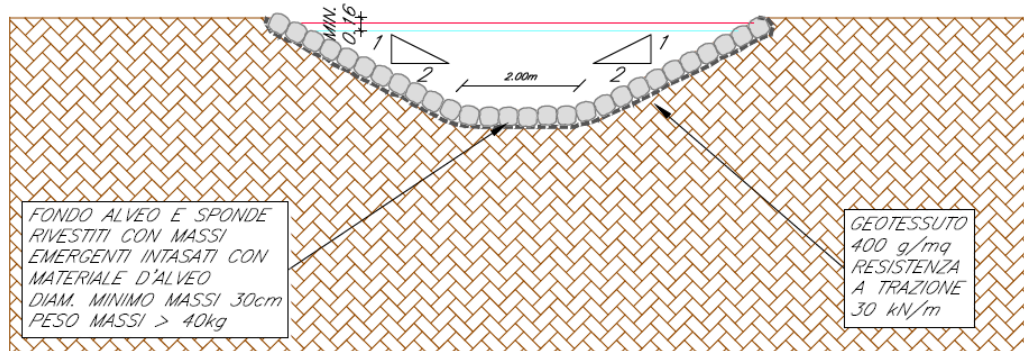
Sezione tipo sistemazione Pk 14+340.
